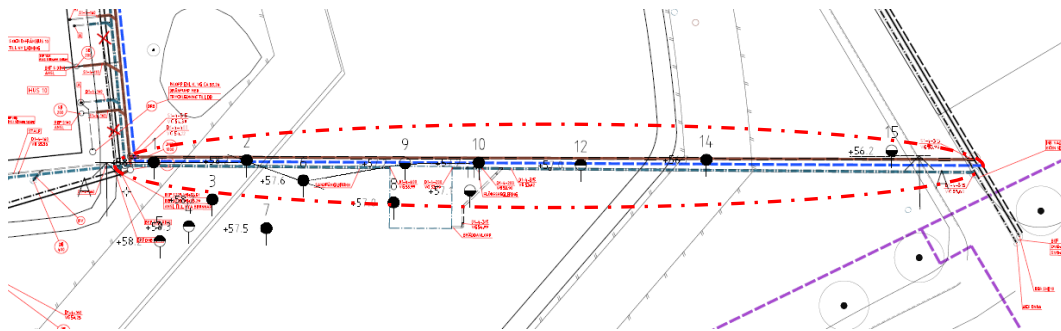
Bilden utgör ett utdrag ur planritning G-10.1-001 ingående i MUR Geoteknik.
